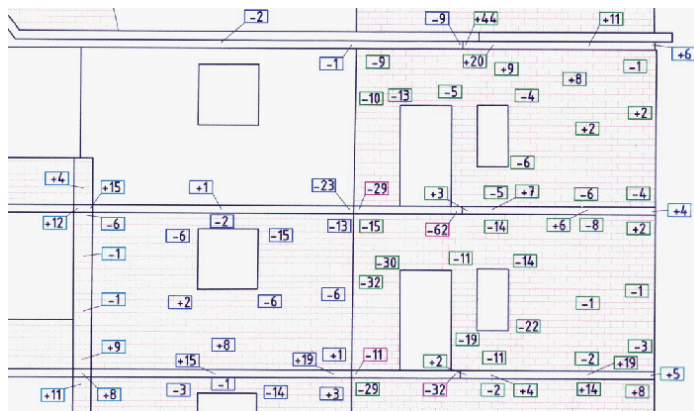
Фрагмент развертки фасада с отклонениями от вертикали кирпичной кладки и бортов перекрытий
